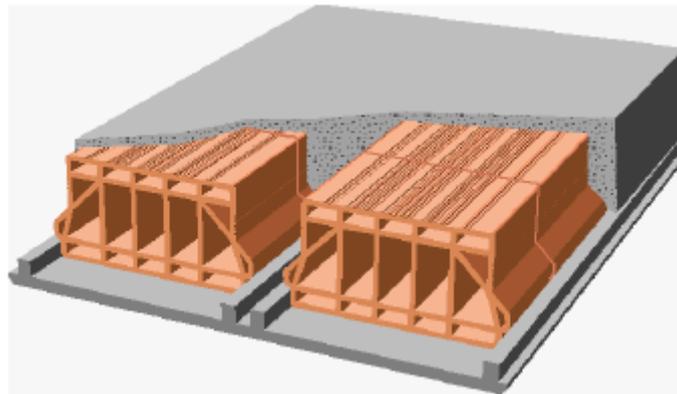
Solaio a pannelli prefabbricati e soletta gettata in opera
